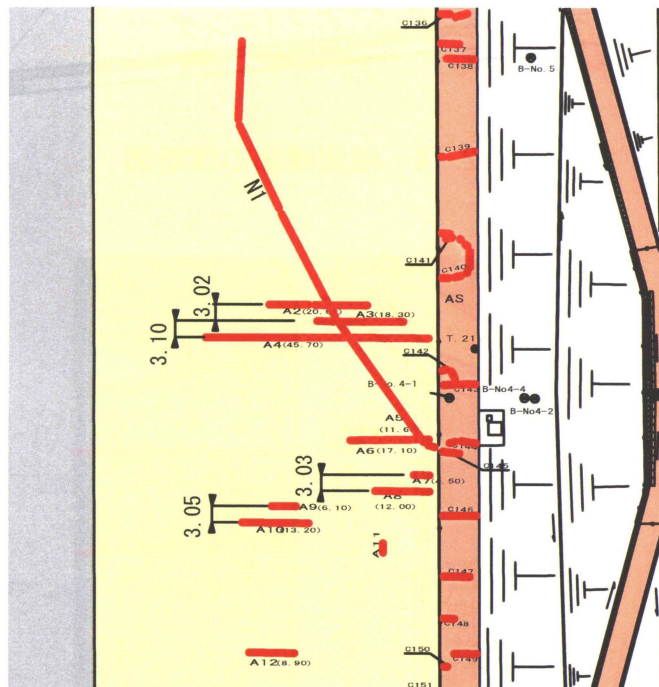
施工継目による亀裂の間隔 (図-2.12 詳細 A の拡大)
